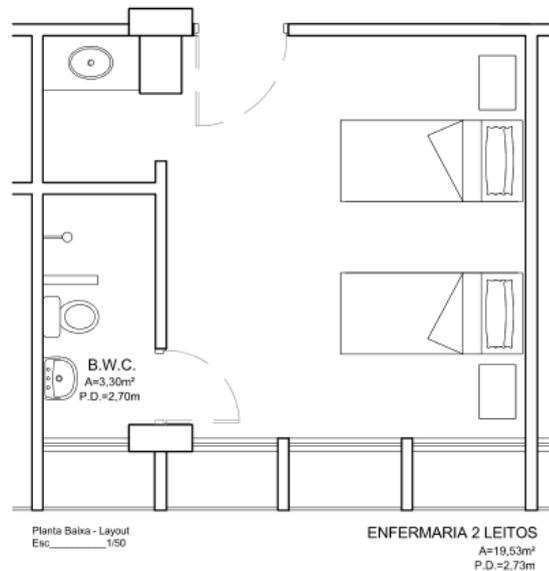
Planta baixa da ala Norte do 8º andar no HC/UFPE
